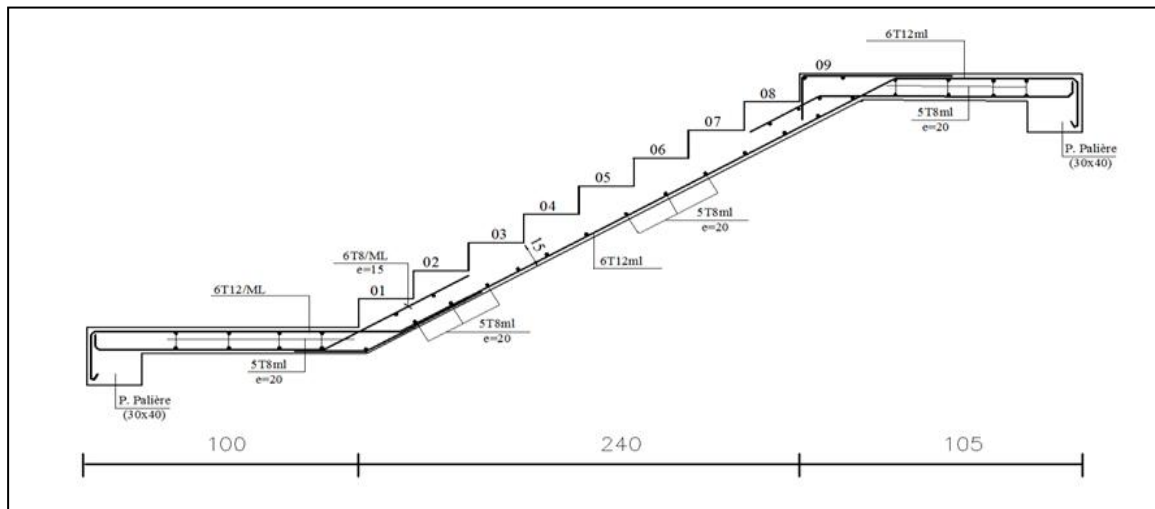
Schéma de ferrailage de l'escalier (RDC) Type 1.
